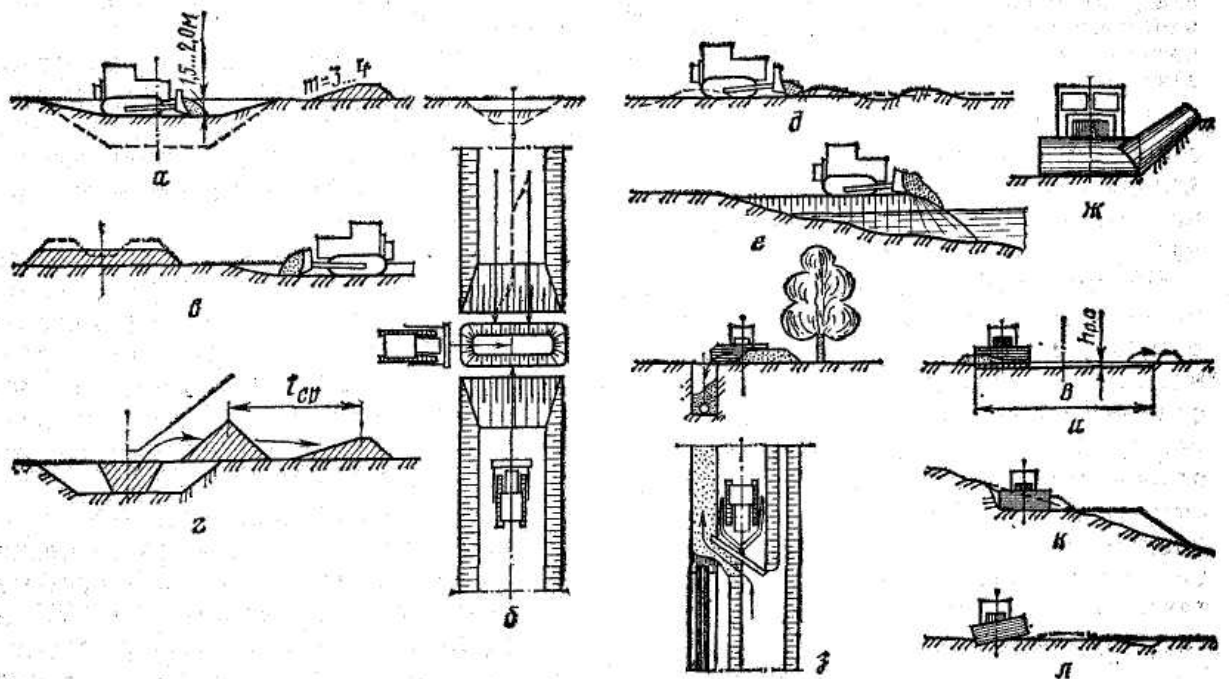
Траншейный способ разработки и перемещения грунта бульдозером
